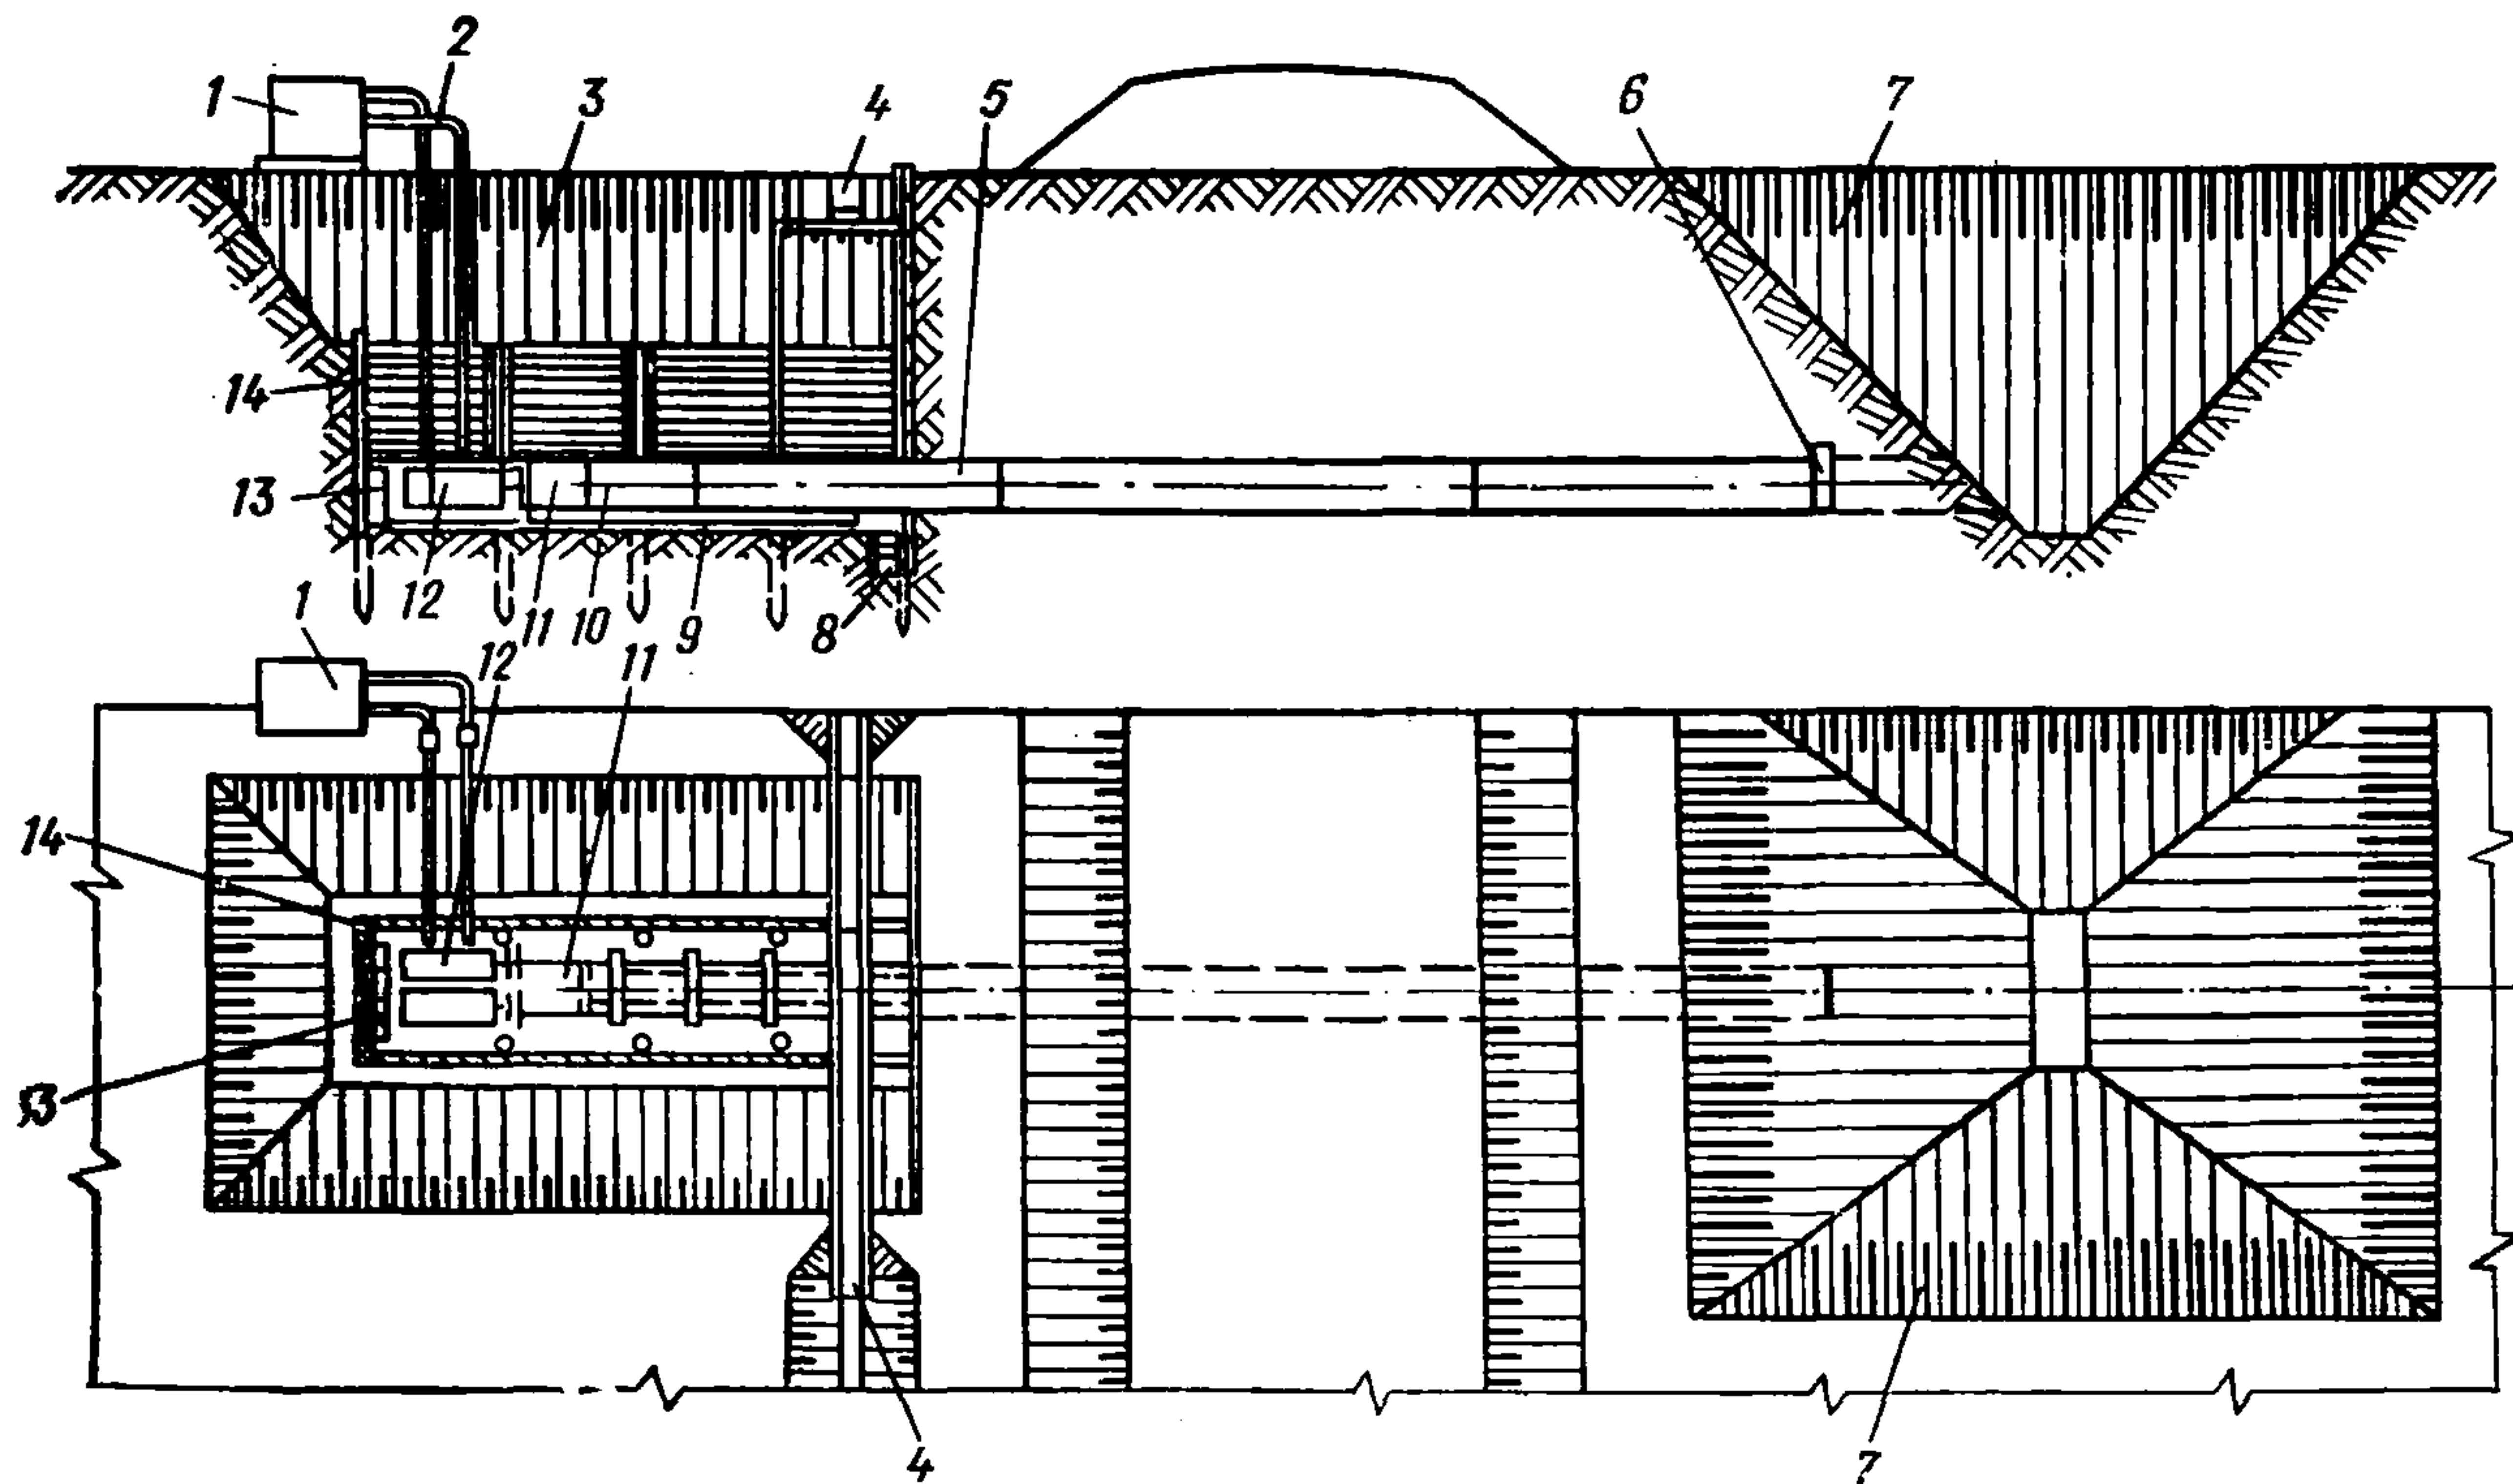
Схема гидродомкратной установки для прокладки кожухов методом продавливания с ручной разработкой грунта
